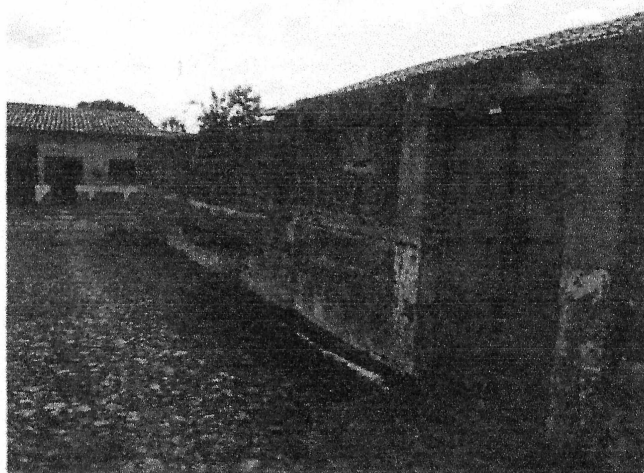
Fachada da edificação com elevado desgaste na pintura e no revestimento argamassado
